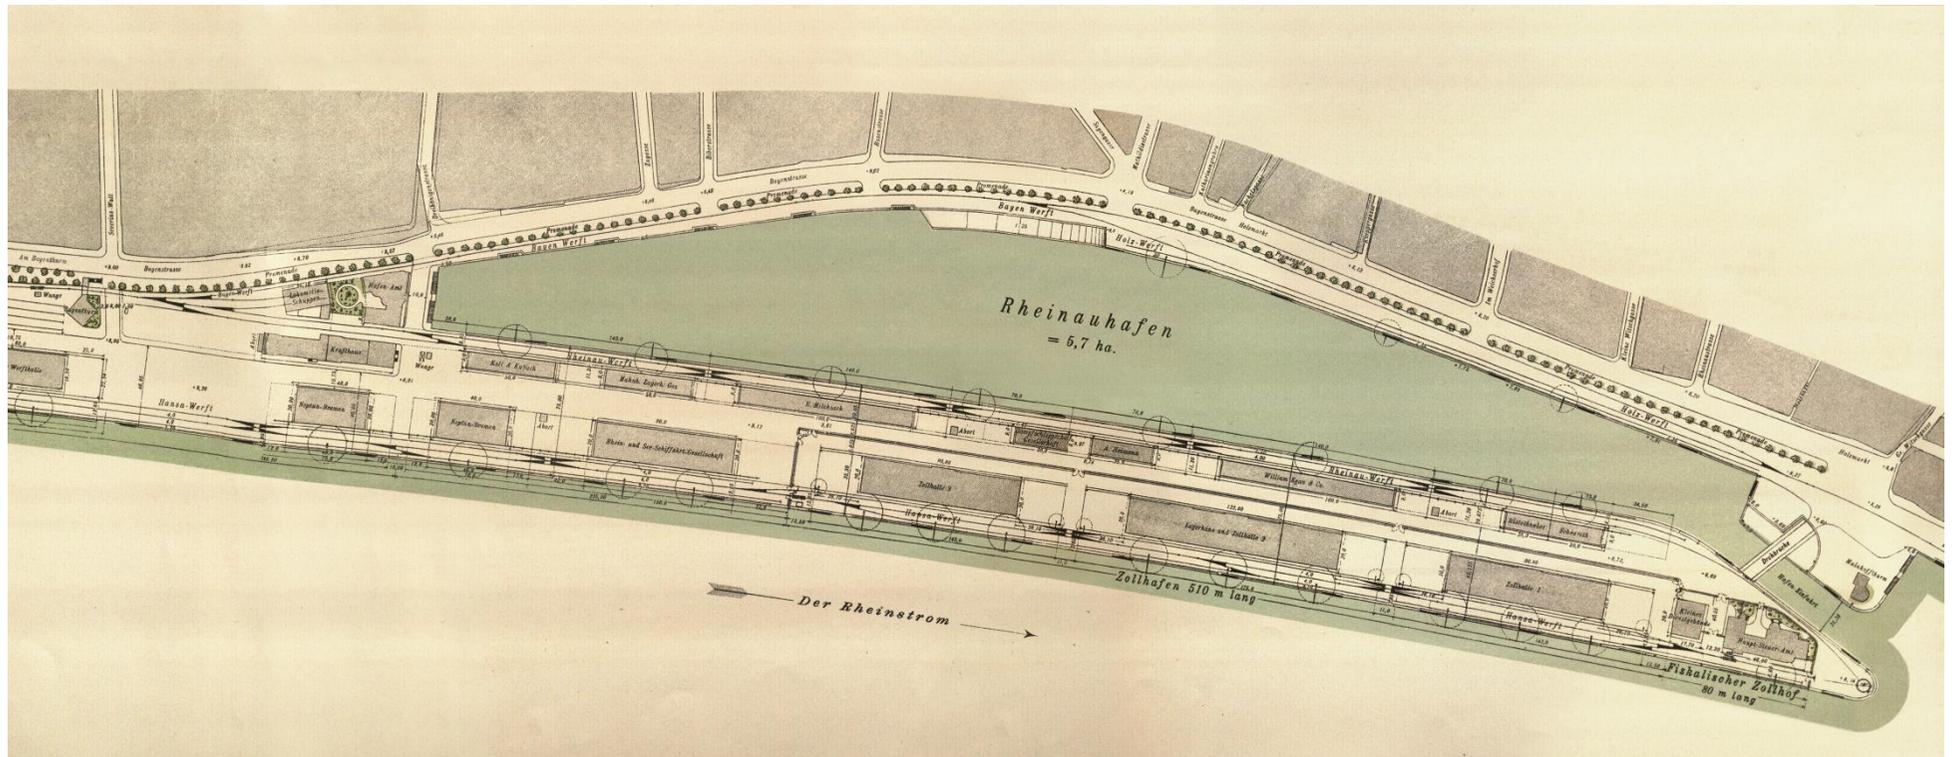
Lageplan der Werft- und Hafen-Anlagen südlich der Schiffbrücke im Jahre 1898 (Ausschnitt). Der neue Rheinauhafen vom Bayenturm (links) bis zur Hafeneinfahrt im Norden (rechts) mit neuer Drehbrücke und dem an die Landseite angebundenen Malakoffturm. Auf der Stadtseite des Hafenbeckens die Bayenstraße und der Holzmarkt.
